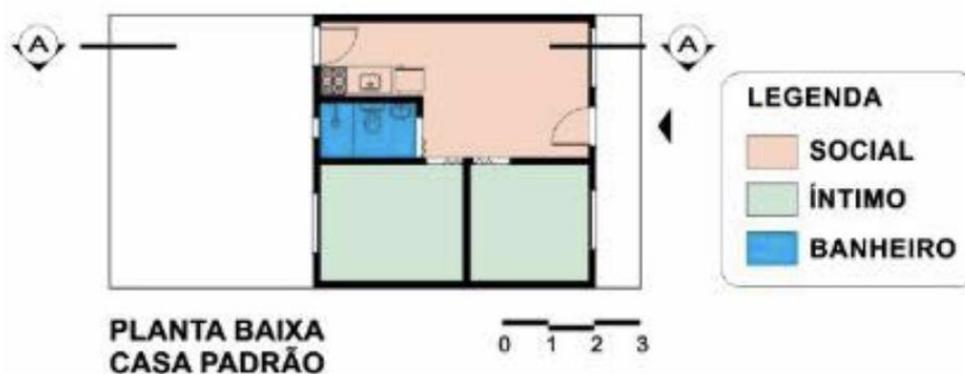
Planta baixa da habitação fita, localizada no conjunto Anglo. Fonte: Jorge et al., 2017.
